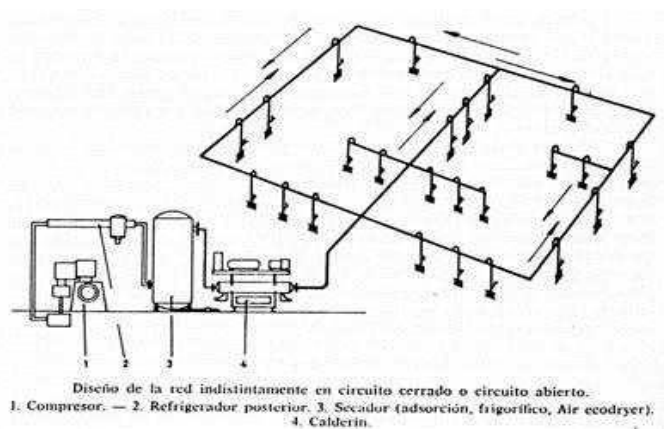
CONFIGURACIÓN CERRADA Y SU AUSENCIA DE INCLINACIÓN
